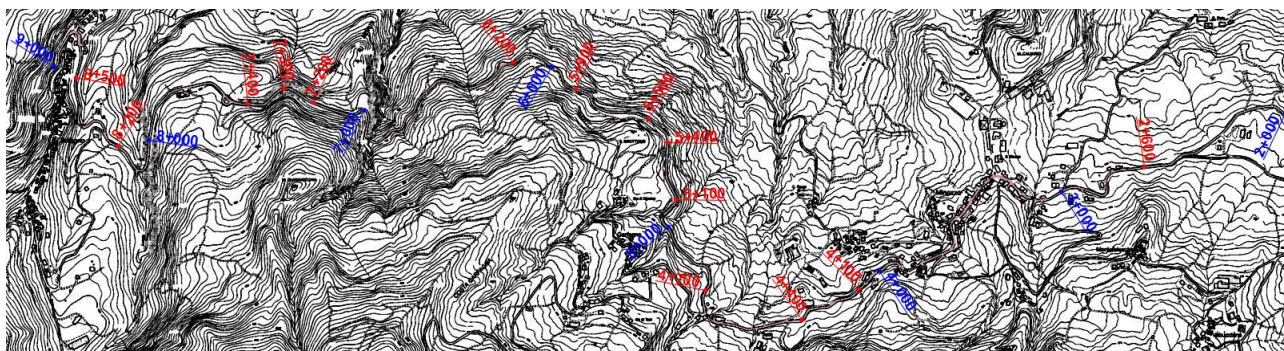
Planimetria strada SP 59 compresa tra le chilometriche di intervento
